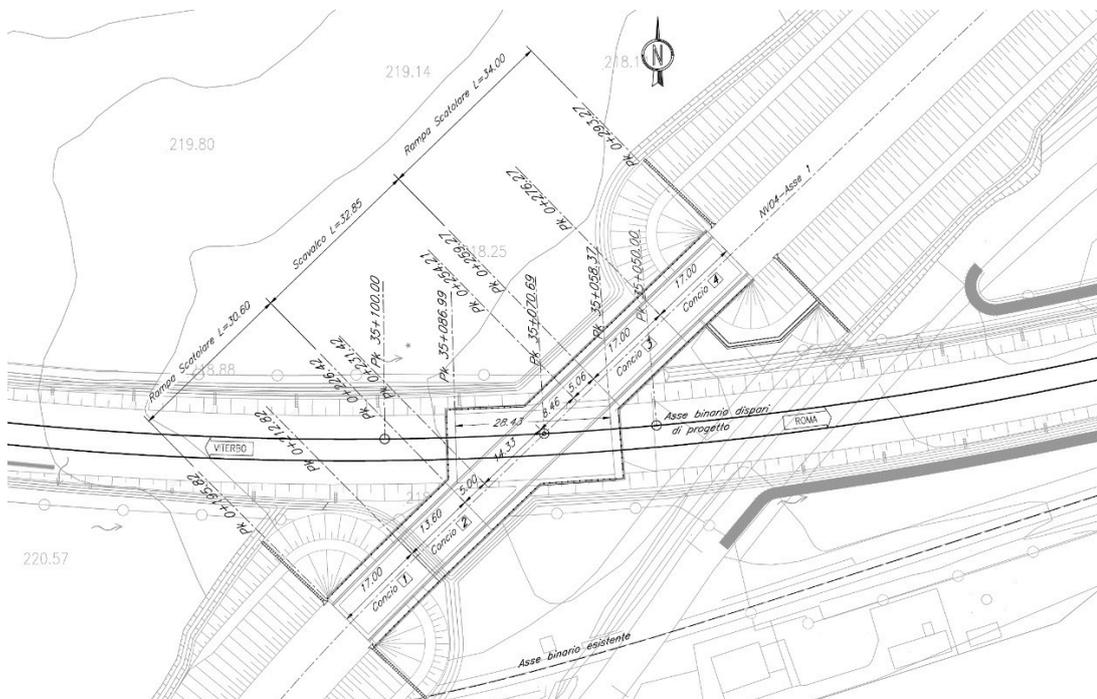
Stralcio planimetrico opera di scavalco al km 35+085
